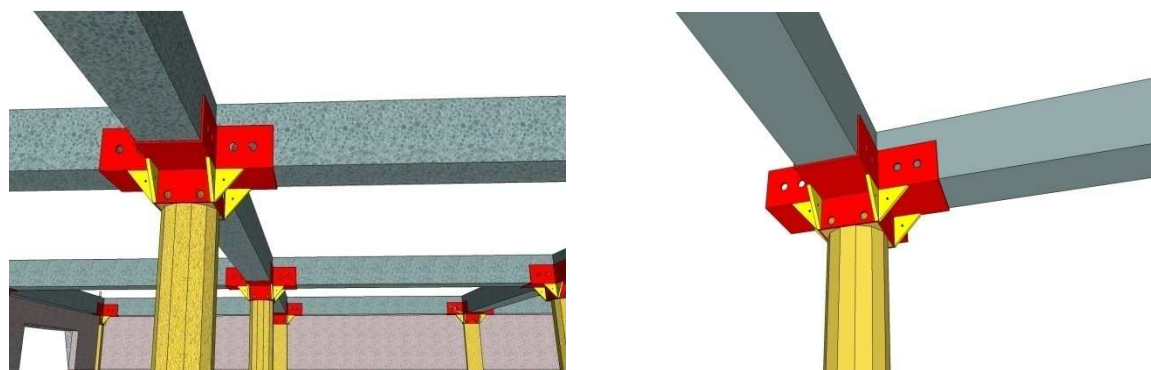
Assemblage entre poteau et poutre par nœud rigide en acier
